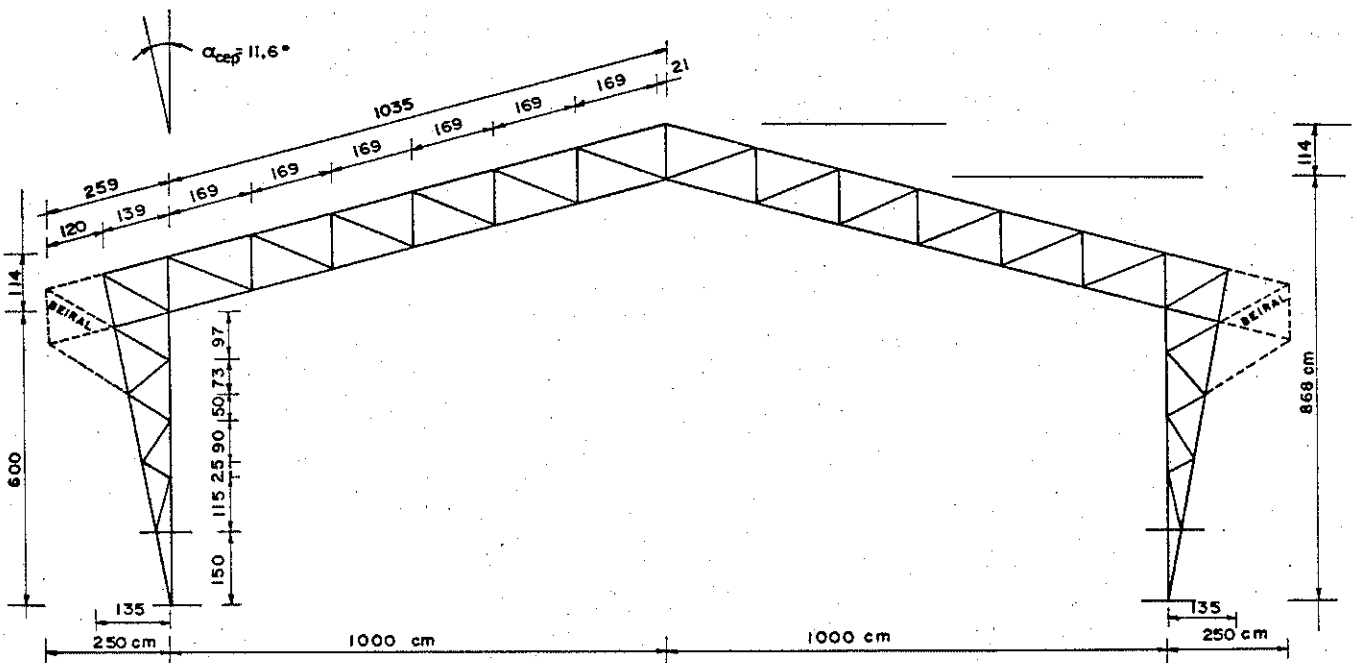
Dimensões Totais do Pórtico
